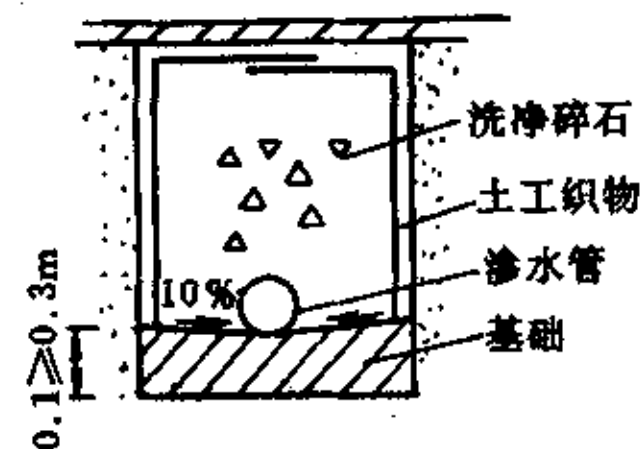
铺设塑料渗水管或软式透水管的渗沟断面示意图
